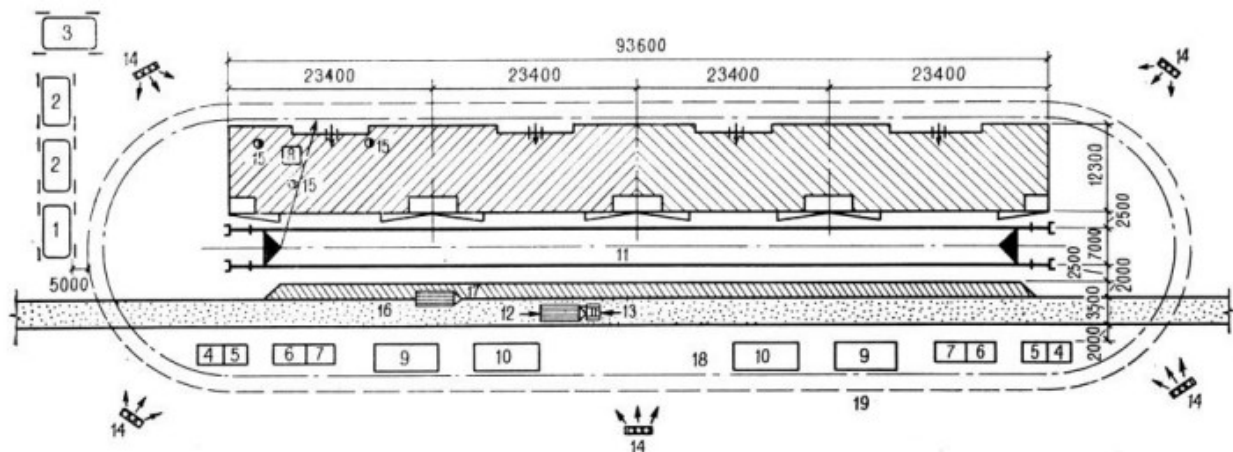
Схема организации строительной площадки при монтаже конструкций «с колес»: 1 – контора прораба; 2 – гардероб с помещением для принятия пищи; 3 – туалет; 4 – склад инвентаря и инструмента; 5 – мастерская; 6 – навес для хранения сантехнических материалов; 7 – навес для столярных изделий; 8 – помещение мастера; 9 – открытая площадка для складирования отдельных элементов; 10 – площадка для приема раствора; 11 – пути башенного крана; 12 – полуприцеп-панелевоз; 13 – тягач; 14 – прожекторы; 15 – светильники; 16 – дорога; 17 – разгрузочная площадка; 18 - зона действия башенного крана; 19 – граница опасной зоны; 20 – склад перегородок для санузлов; 21 – склад внутренних стеновых панелей; 22 – склад перекрытий; 23 – склад наружных стеновых панелей; 24 – склад гипсобетонных перегородок; 25 – склад вентиляционных блоков и электропанелей; 26 – склад стеной лоджий; 27 – автомобильный кран.
